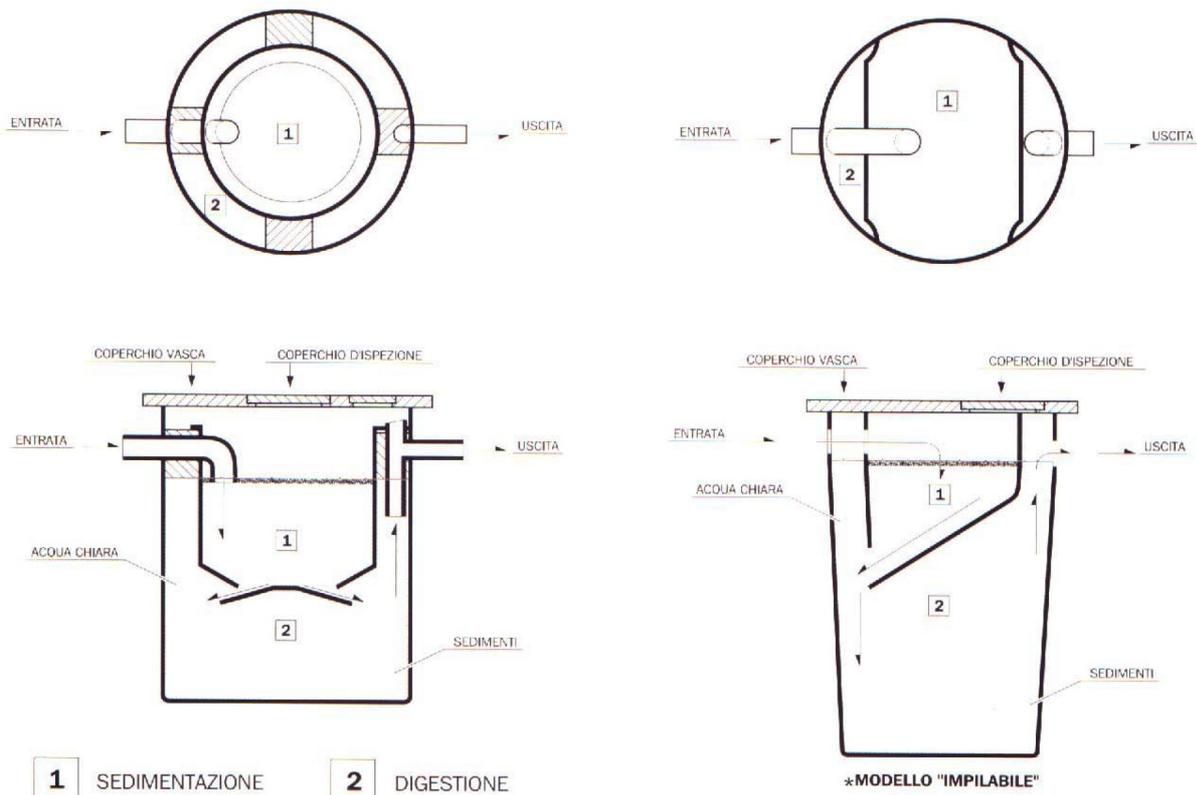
rappresentazione schematica di vasche imhoff (pianta e sezione)
